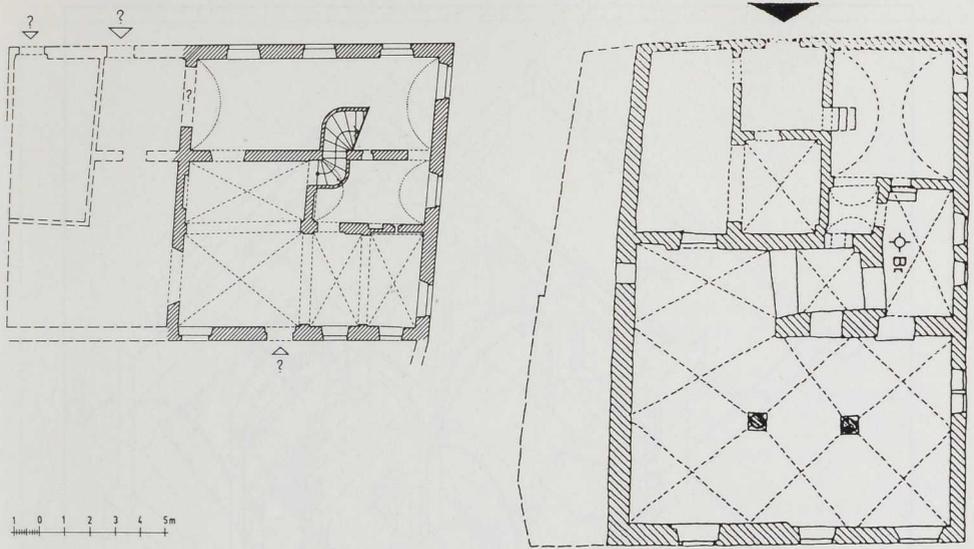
Ravensburg, Stadelgasse 1, die Erdgeschoß-Rekonstruktion des Ravensburger Bades weist Parallelen zum Ulmer Badhaus des frühen 16. Jahrhunderts auf.
